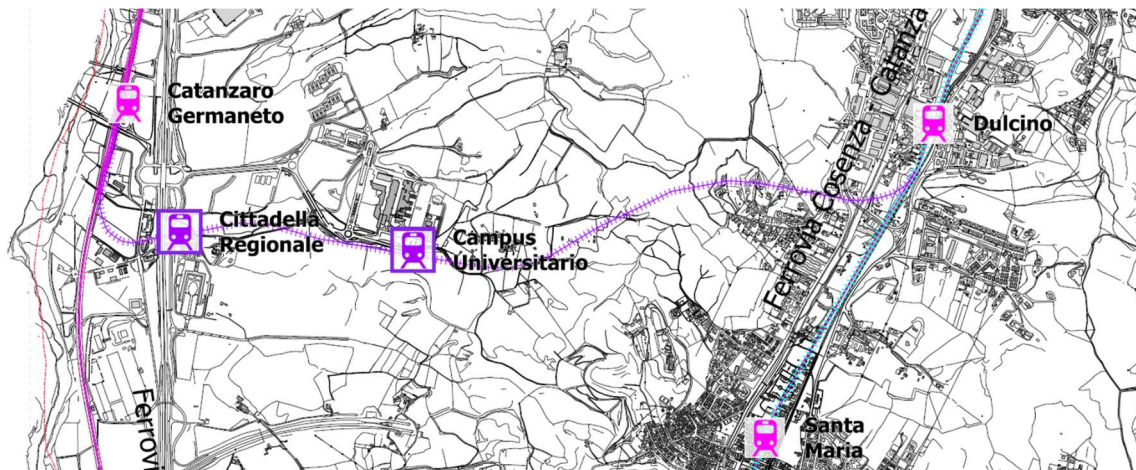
particolare della planimetria del progetto -collocazione delle nuove stazioni (PUMS Catanzaro)
